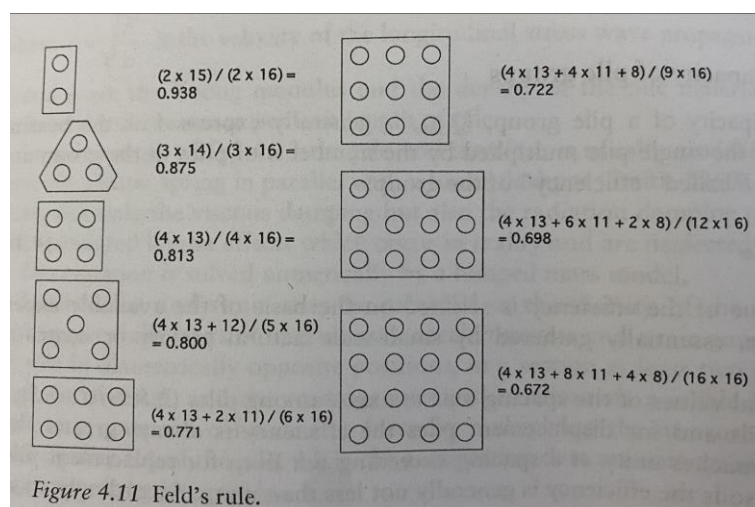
estratto da *Piles and Pile Foundations*, Viggiani Mandolini e Russo
